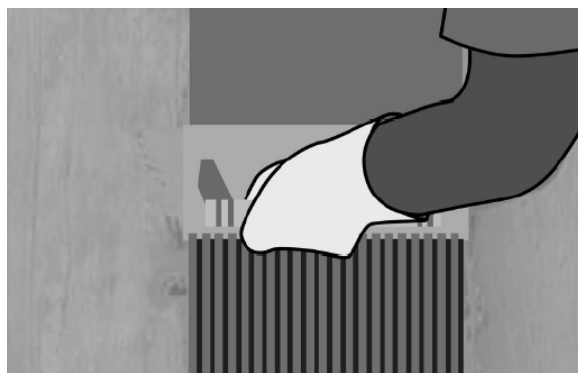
Exemplo de aplicação de argamassa colante em estrutura de concreto armado com a utilização de desempenadeira de aço (fonte: retirado de documento da construtora X).
